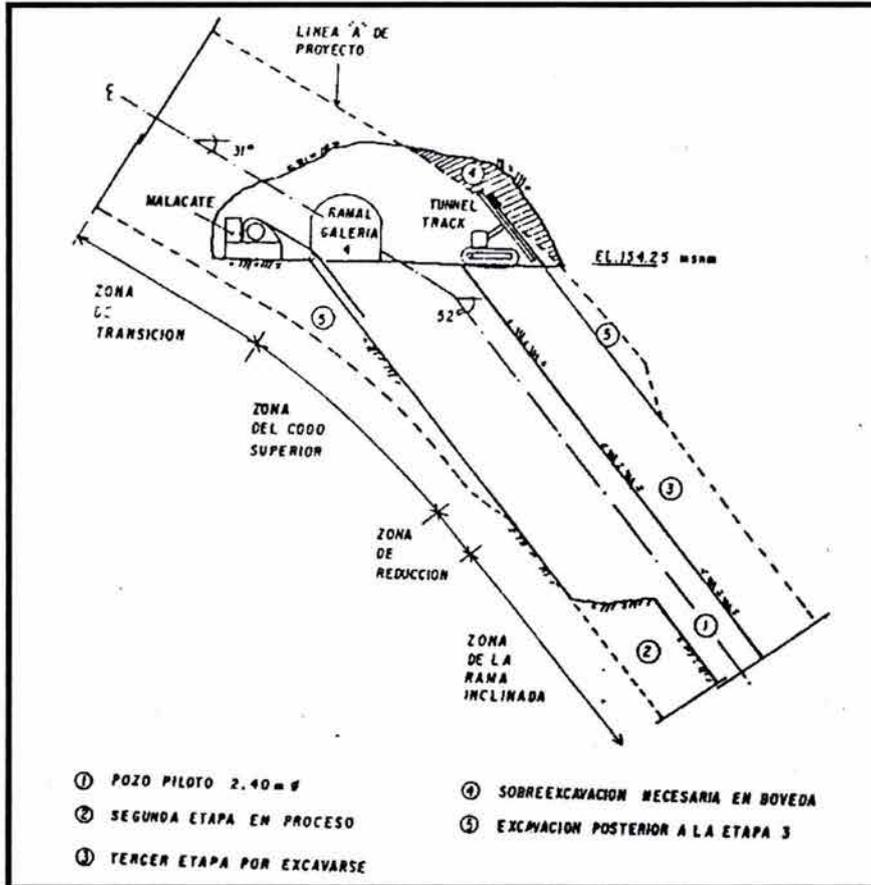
EXCAVACIÓN DE LA TERCERA ETAPA,
